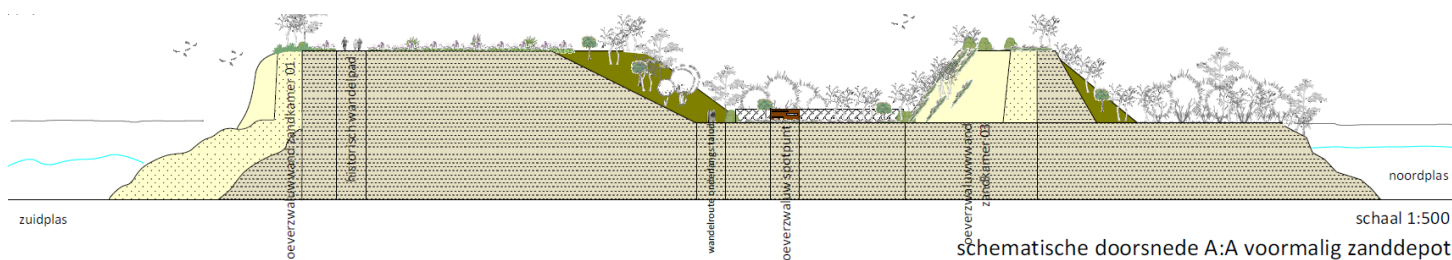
a.3 Uitwerking van het landschappelijke inpassingsplan met terrein grensaanduiding (Bron: Architectenburo Agterberg)
